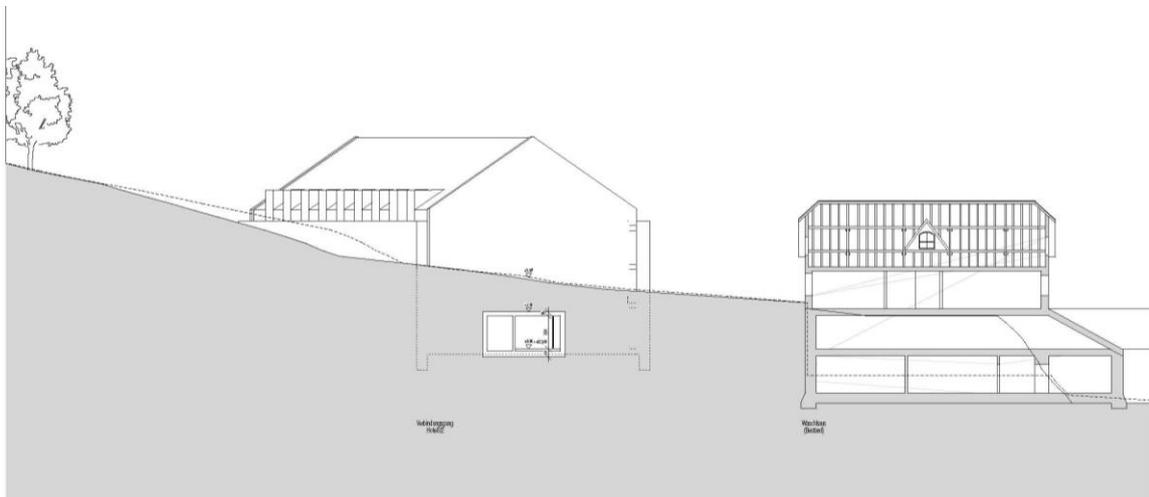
Schnitt BB, Blick auf Haus 2 mit Querschnitt Verbindungsgang Haus 1 zu Haus 2 (mit Erde überdeckt) und bestehendes Wirtschaftsgebäude - Waschhaus
